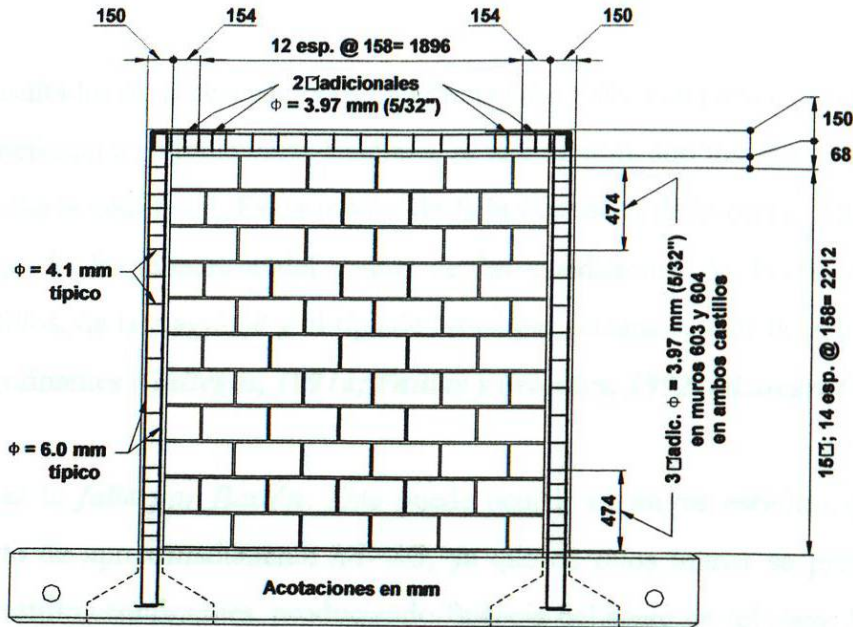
Armado de muros: 601, 602, 603 y 604
